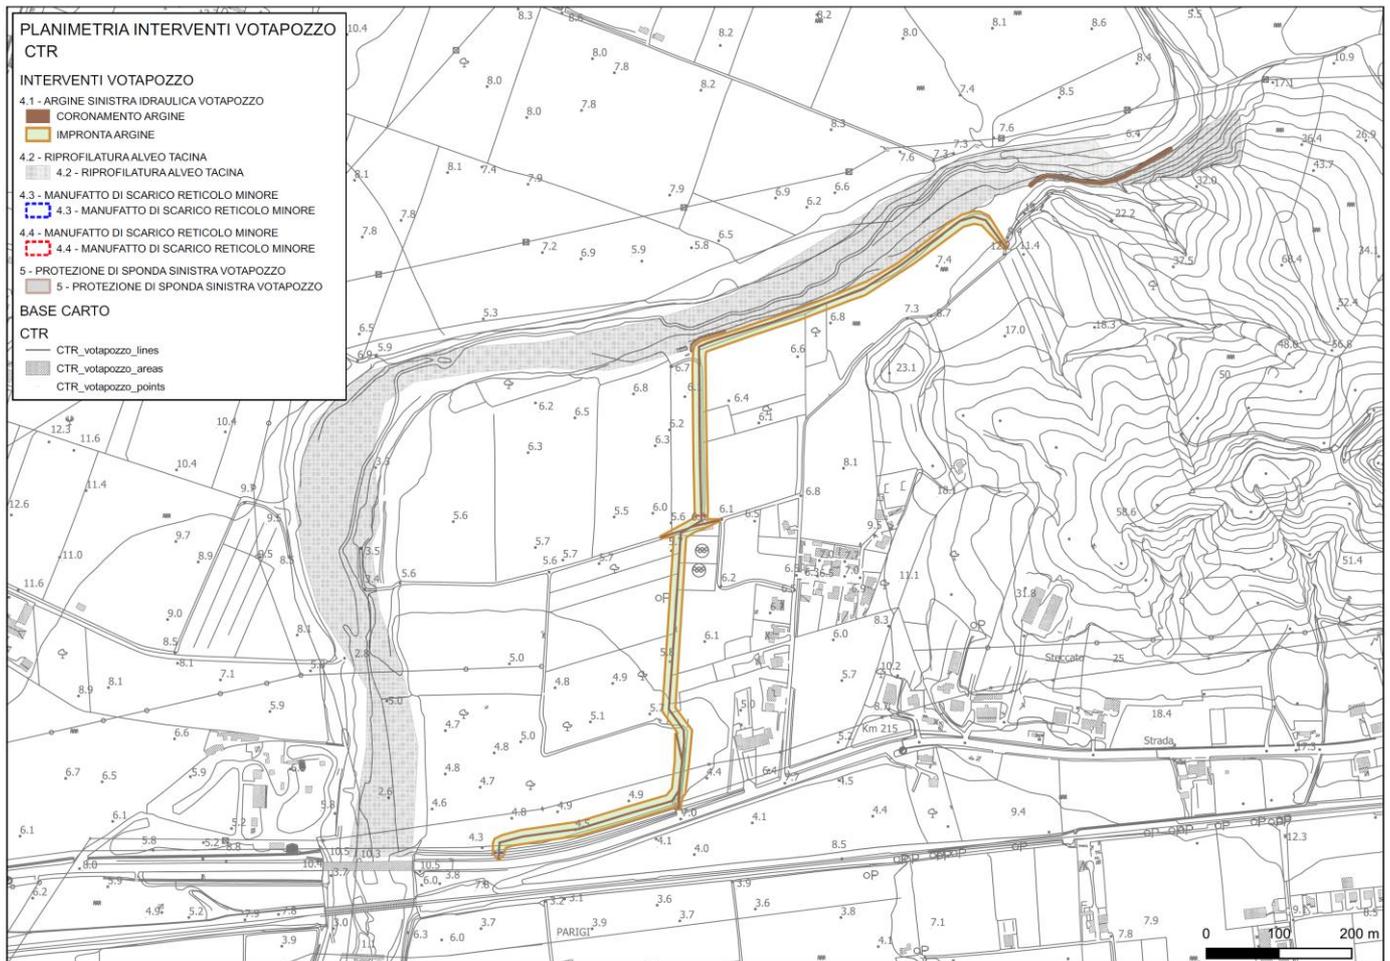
Planimetria generale interventi previsti in Località Votapozzo - Steccato di Cutro (KR)
